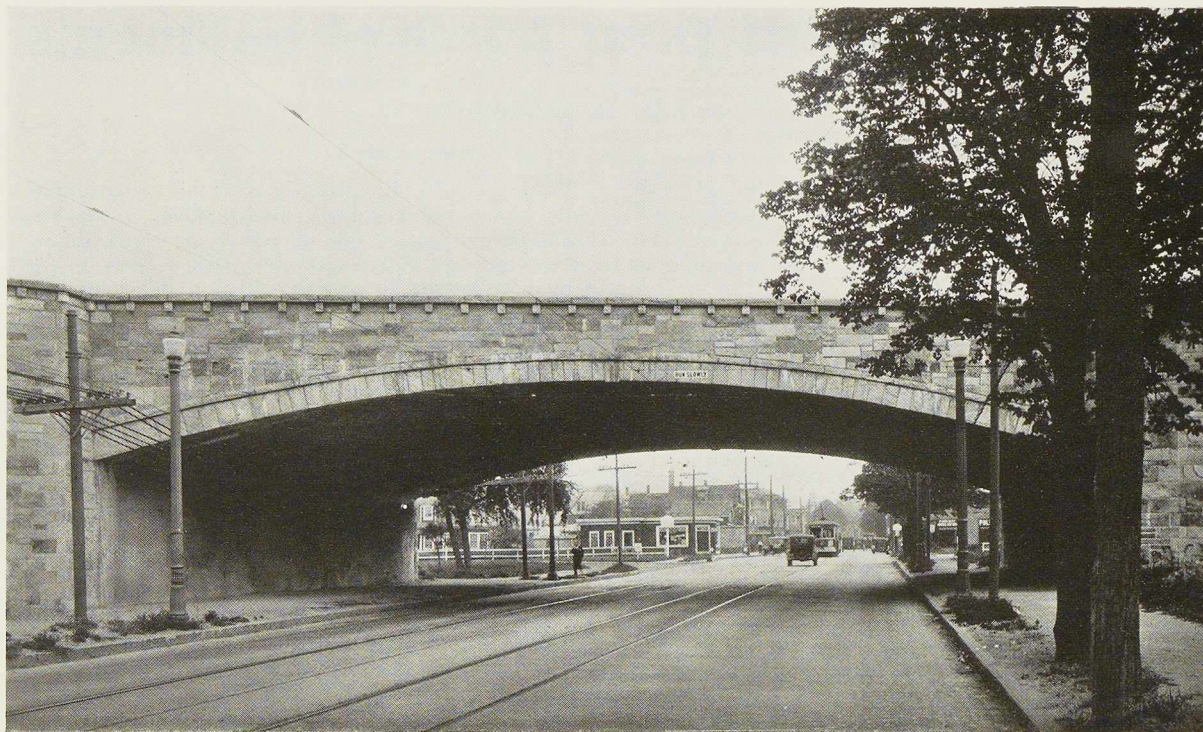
Vue d'un pont à béquilles en acier revêtu d'un parement en pierres.
